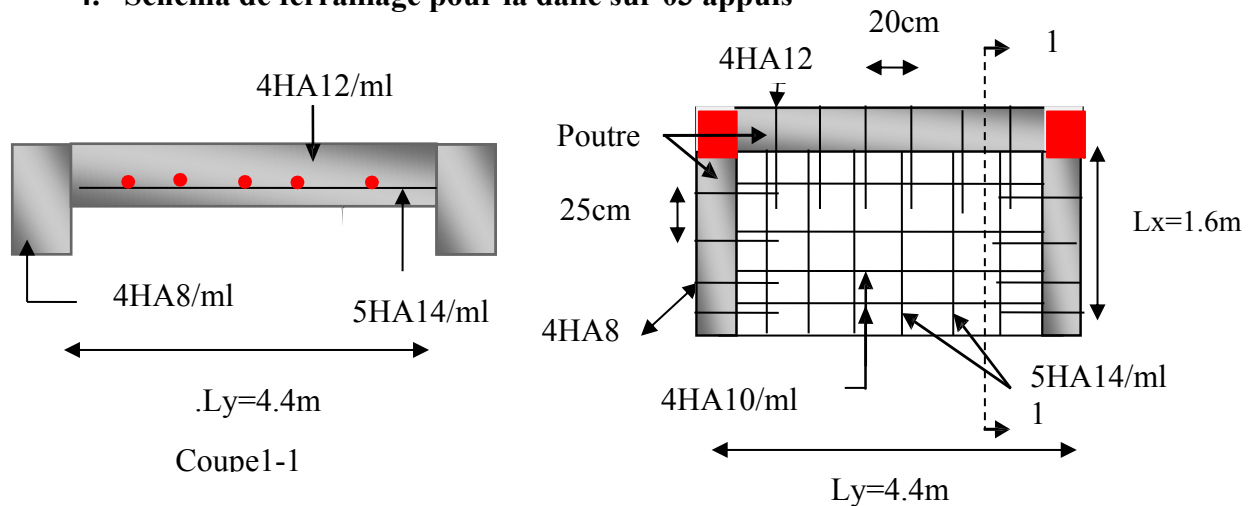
Schéma de ferrailage de la dalle pleine sur 3 appuis
